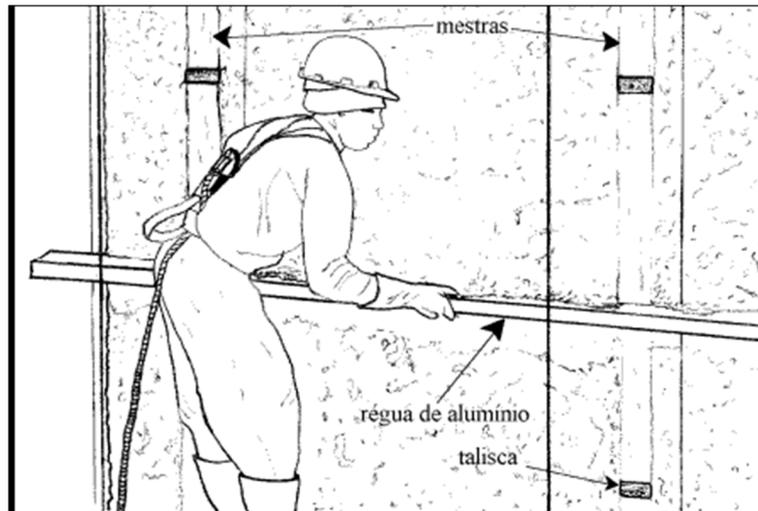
Execução de reboco interior (Fonte: <http://construcaociviltips.blogspot.pt>)
